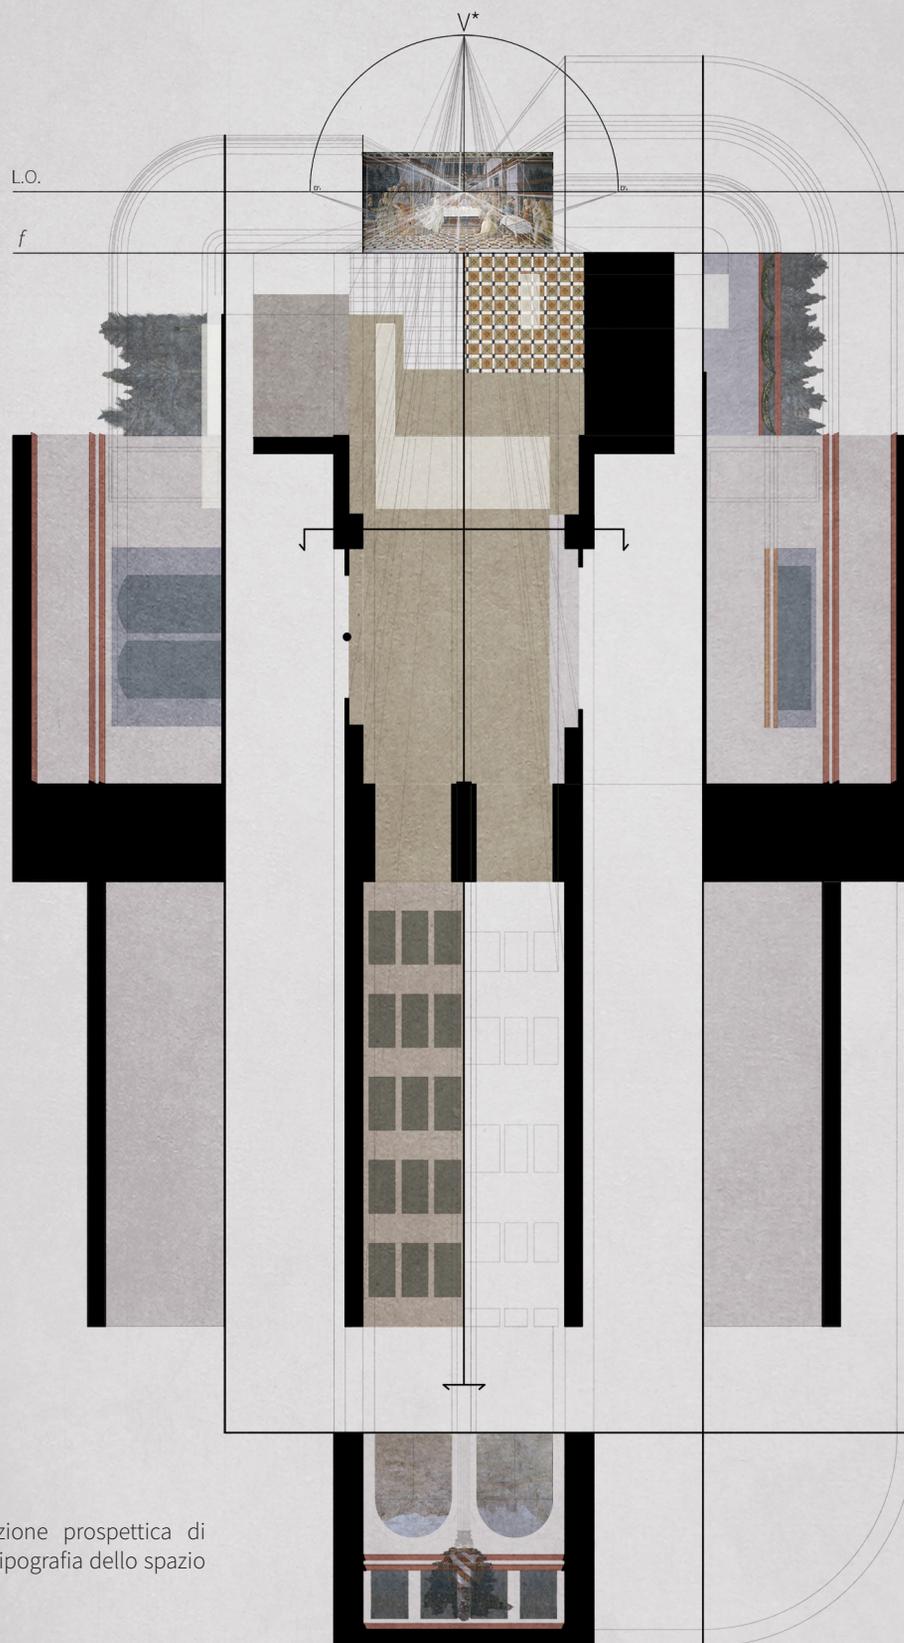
Restituzione prospettica di pianta, sezioni e ipografia dello spazio dipinto.
